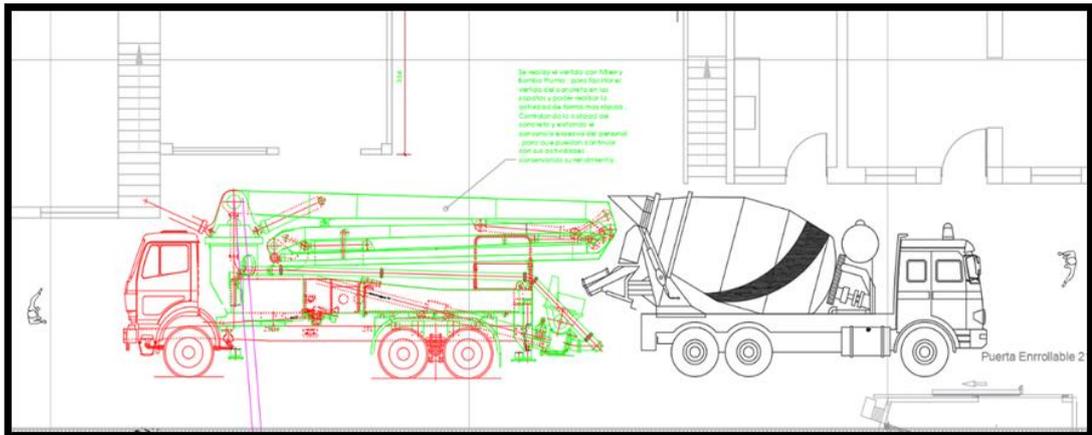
Corte de Layout de Vertido de Concreto con Mixer y Bomba Grúa
